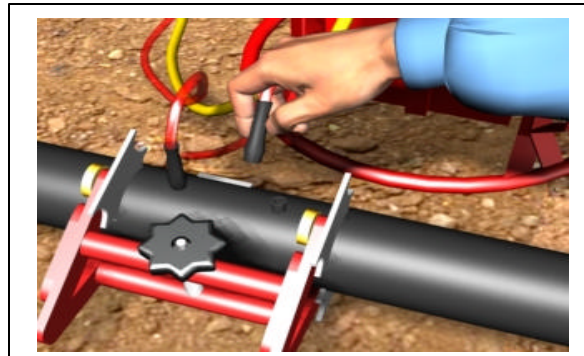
O alinhador será instalado e o cabo da máquina conectado aos bornes da conexão.
